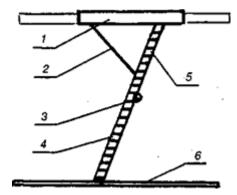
Складная чердачная лестница: 1 — люк; 2 — упор; 3 — шарнир; 4 — лестница;5—крышка пол
